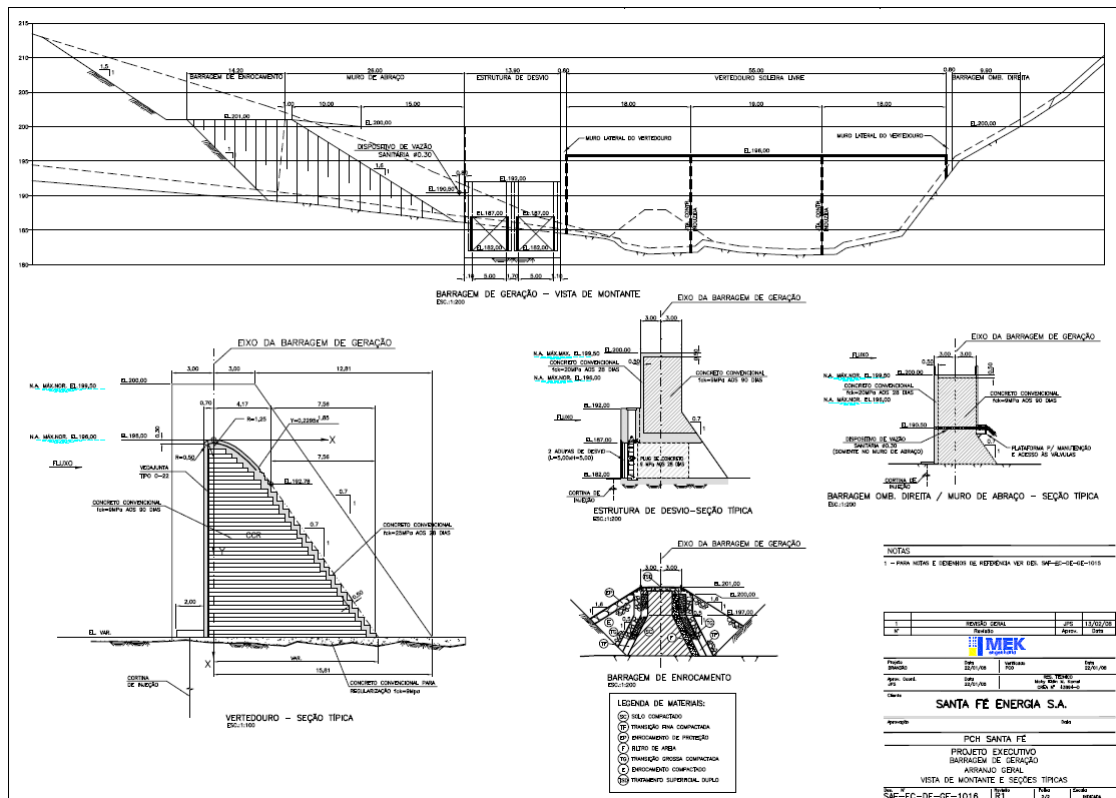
Barragem de Geração – Vista de montante e Seções.
